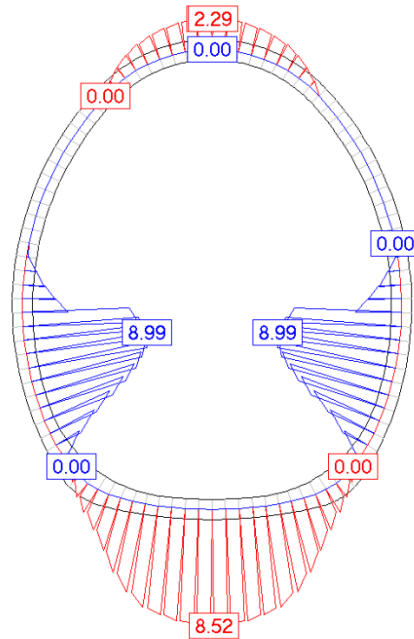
Secção VR3.6. Armaduras de cálculo de flexão (cm^2/m)
